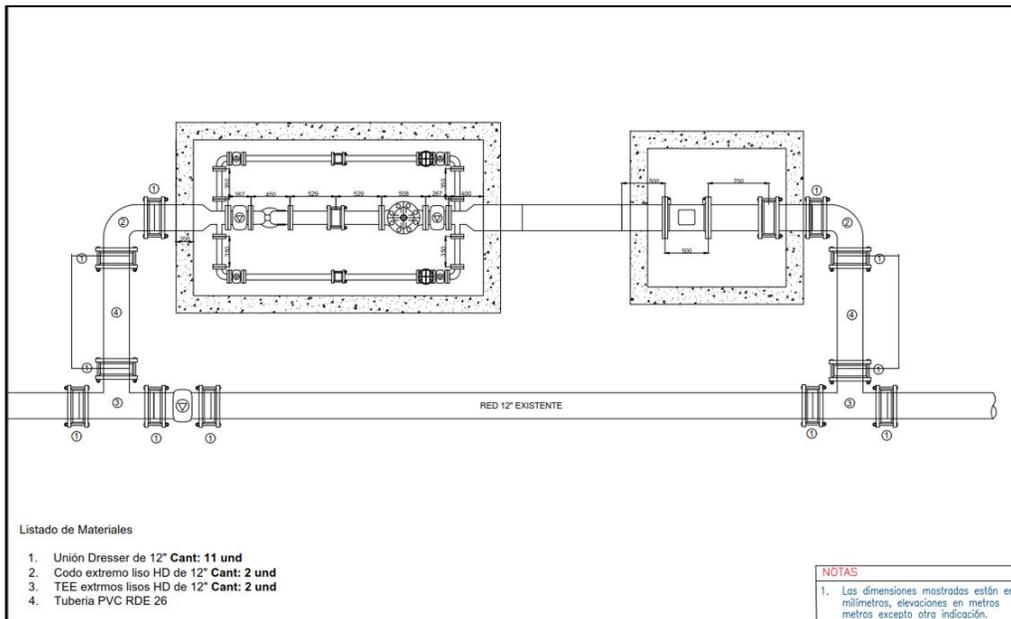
Plano As-Built Instalación Mecánica VRP y Macromedidor Planta, Fuente: Consultor Constructor
